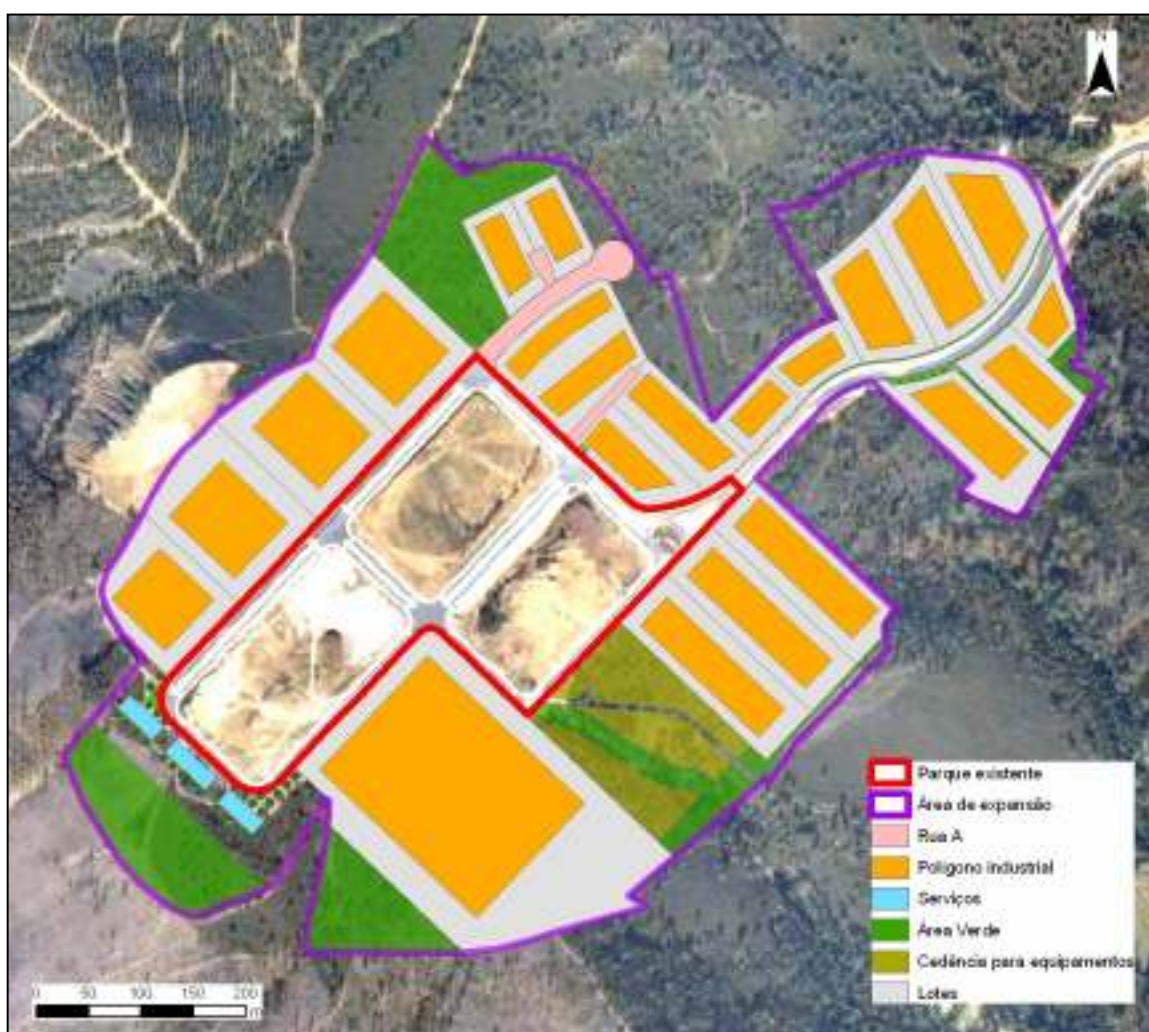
Planta do loteamento da expansão do Parque Empresarial de Paredes
